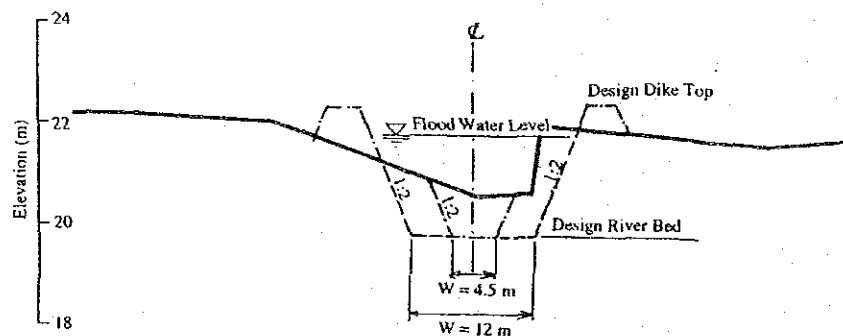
Profil en travers types des travaux d'aménagement (1/2)
